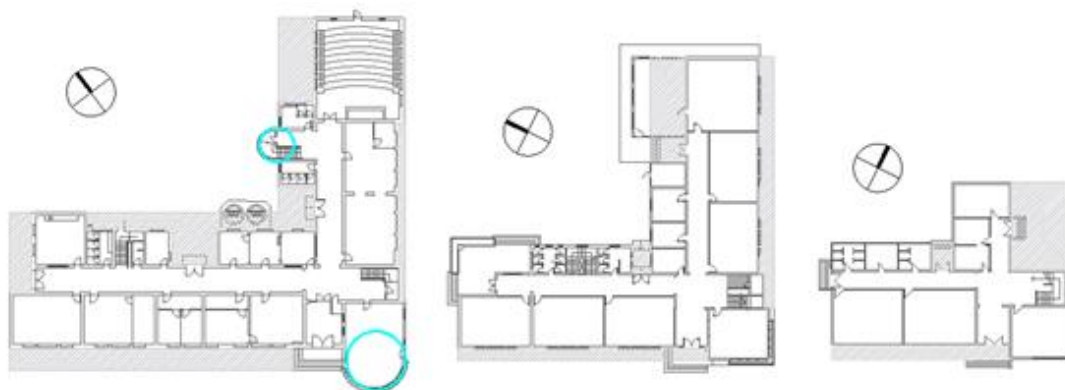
Planta baixa do 1º pavimento das escolas Assis Brasil, Joaquim Caetano e Marques de Souza.
